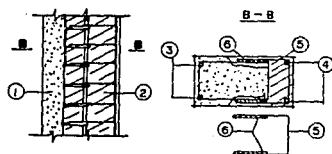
Conexión por medio de estribos soldados
